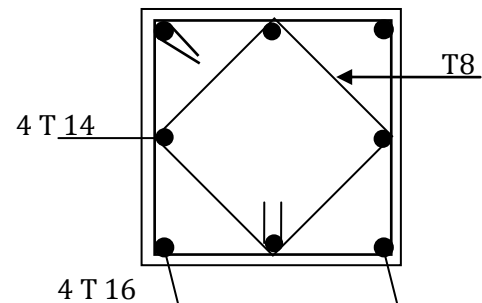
Schéma de ferrailage des poteaux 12<sup>ème</sup> étage
